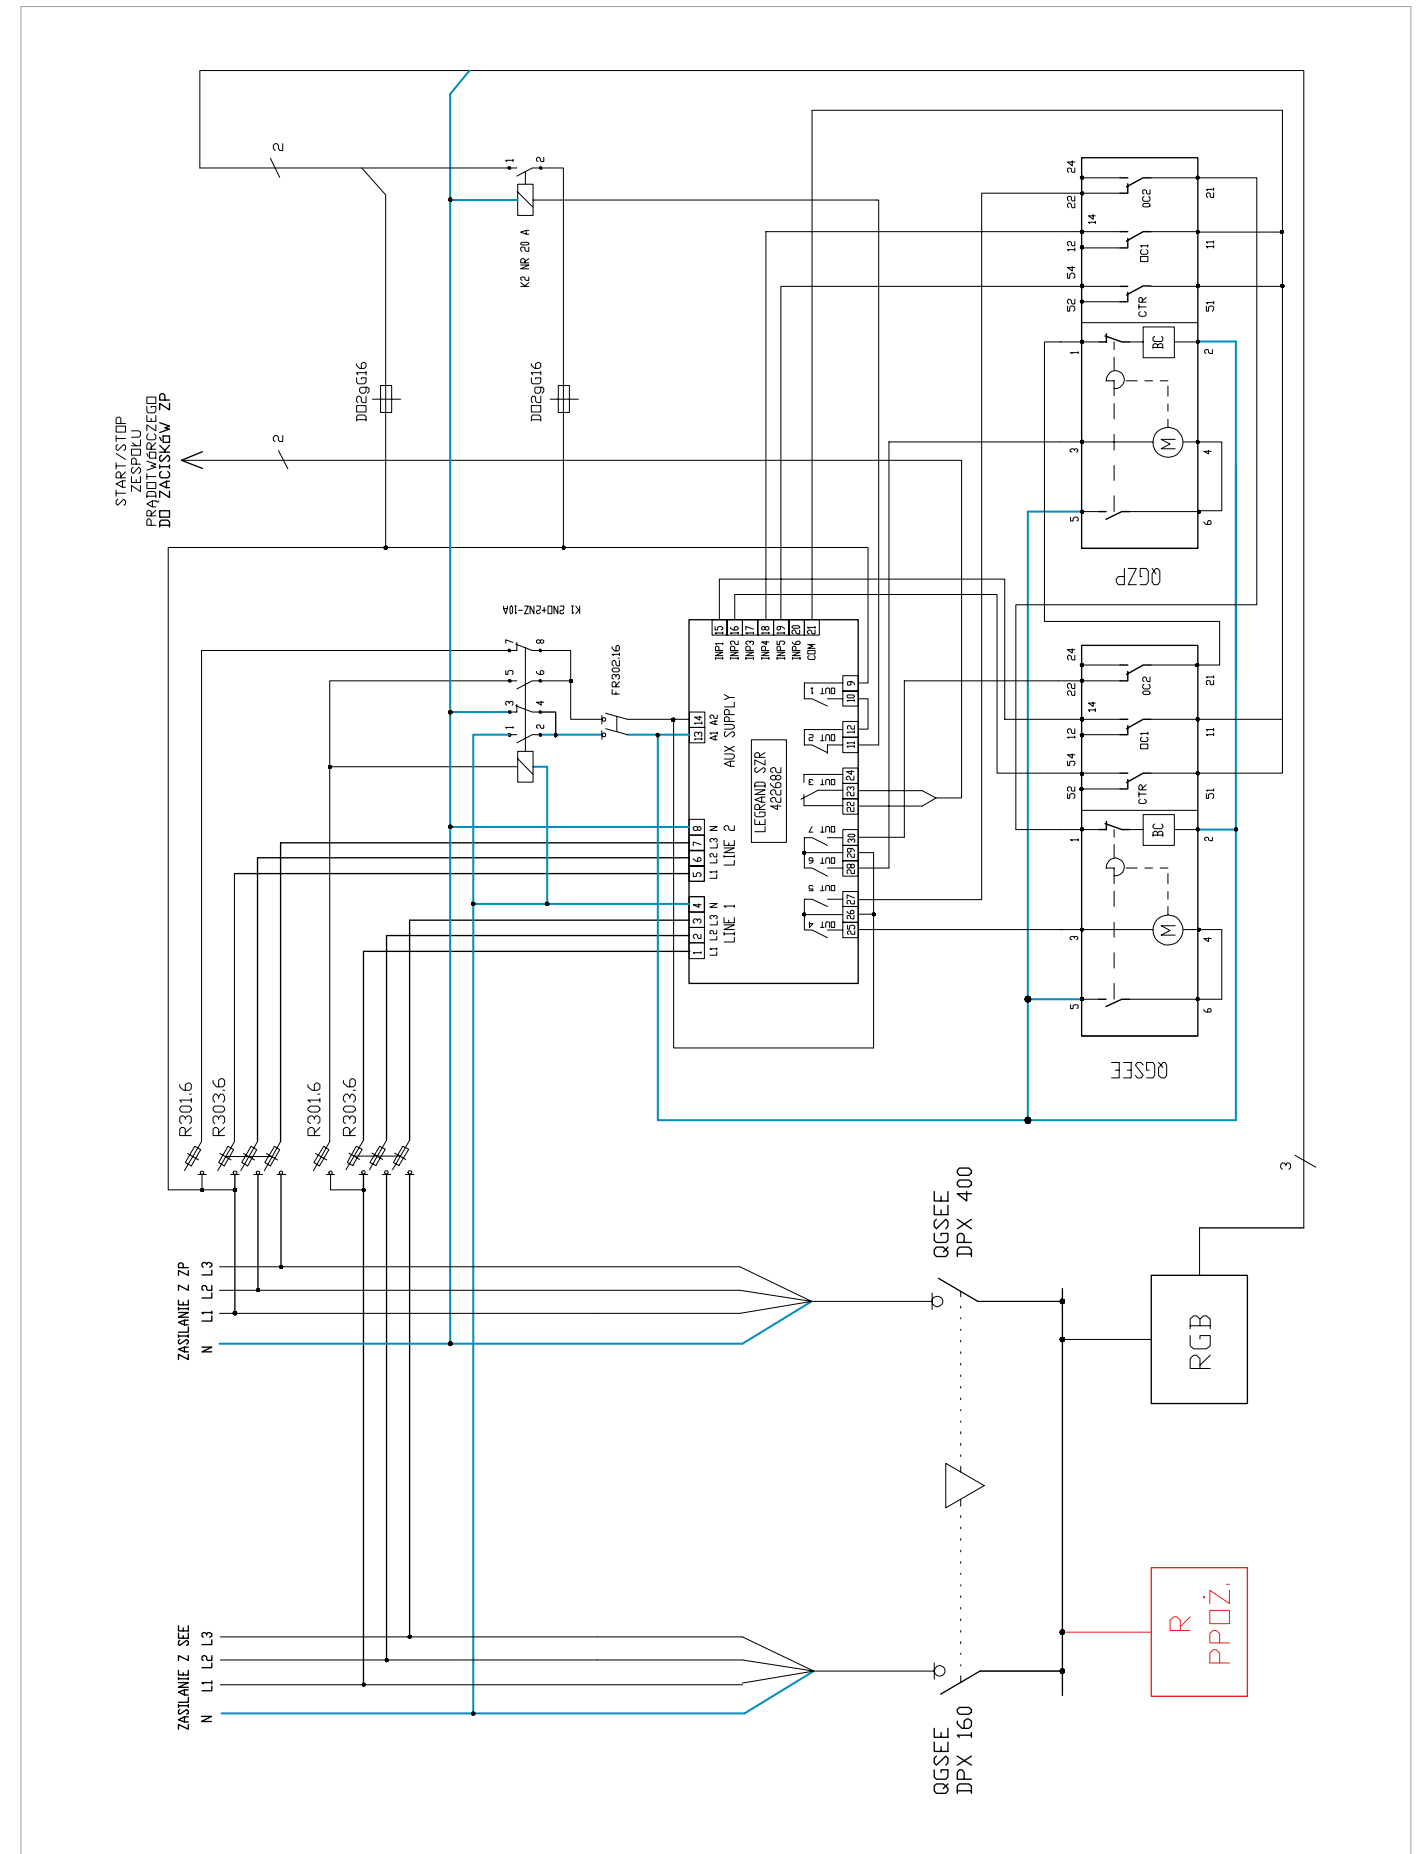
Plan zasilania kompleksu rys. J. Wiatr
